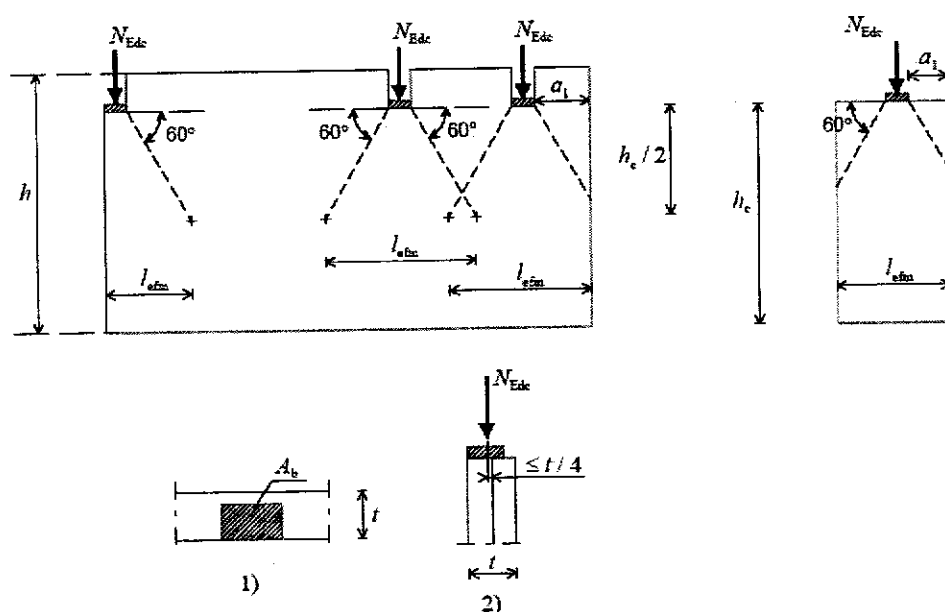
Pareti soggette a carichi concentrati. 1) pianta, 2) sezione
